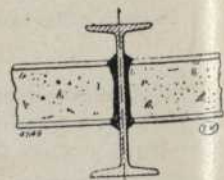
Esquema de la soldadura de les biguetes longitudinals sobre ànimes d'unió d'angle
